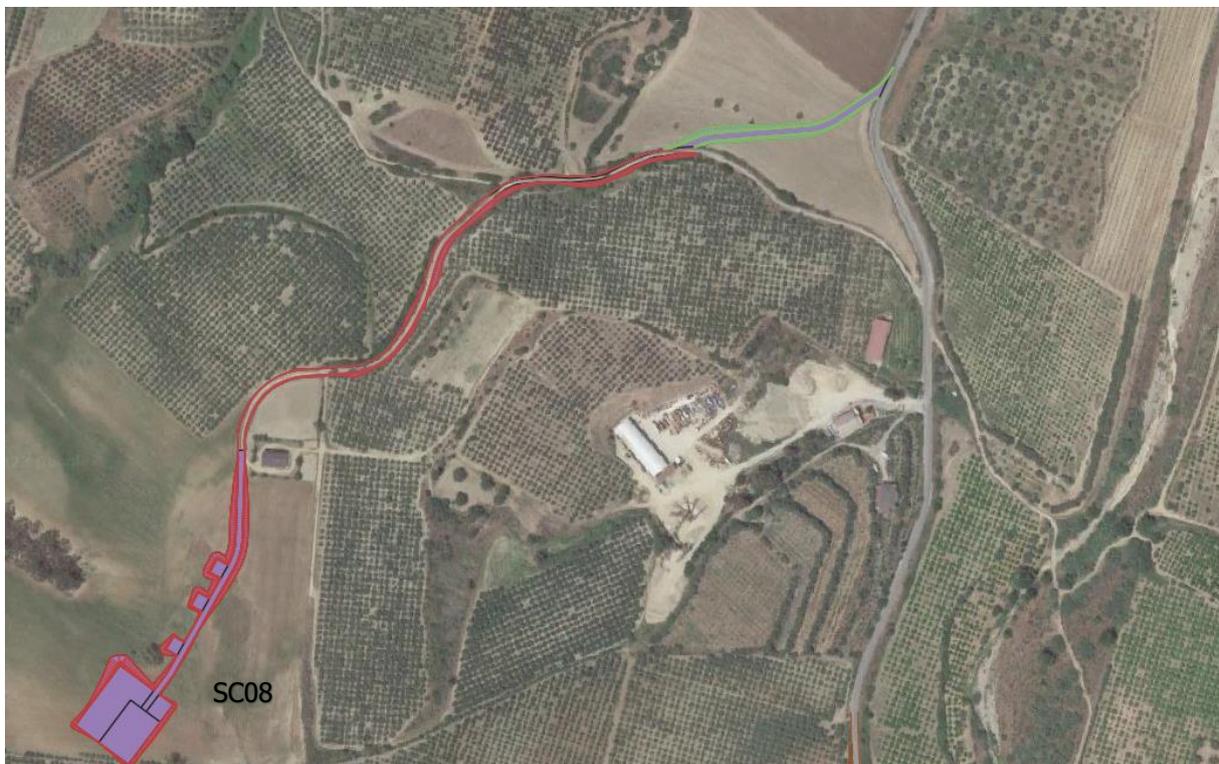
Nuovo tratto stradale di collegamento tra SP186 a piazzola di SC08
